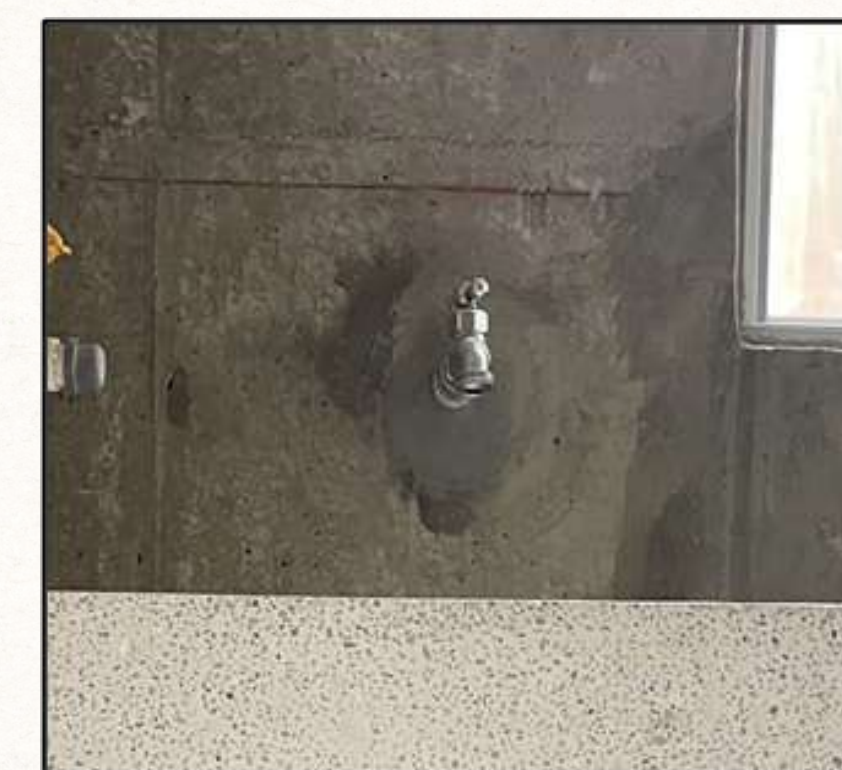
Grifería de Lavadero: Llave Jardín Cromada.
